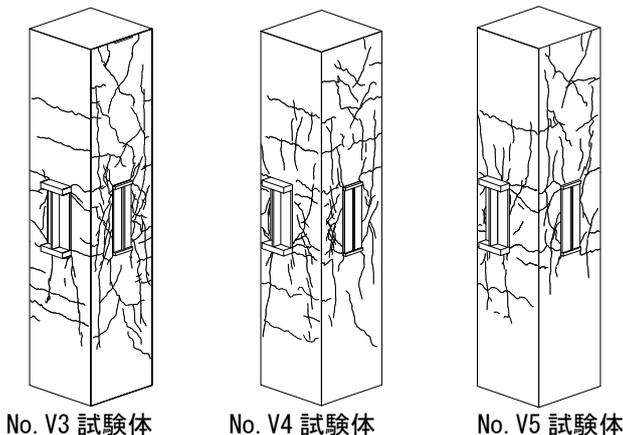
$R=20/1000(\text{rad.})$  時のひび割れ状況
